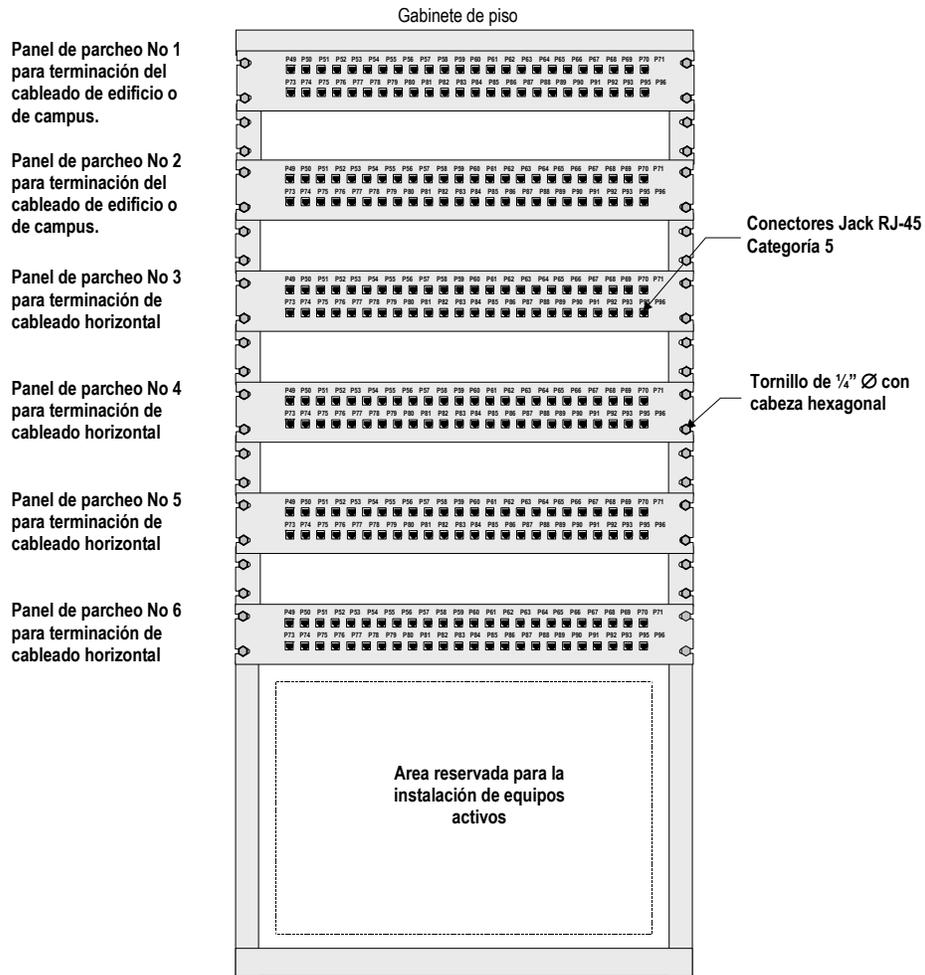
Ejemplo de distribuidor de cables equipado con paneles de parcheo.
